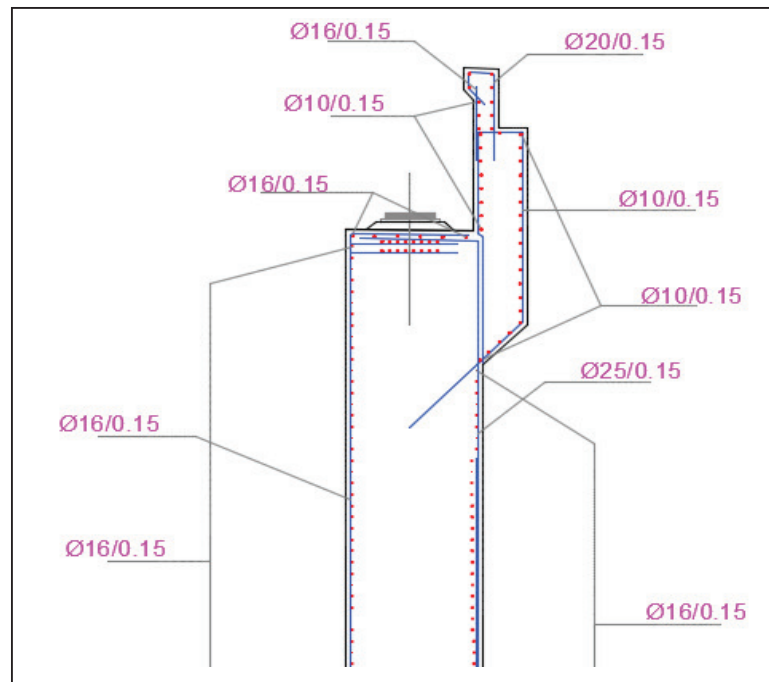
Ferrailage du mur de fond, mur garde grève et corbeau.
